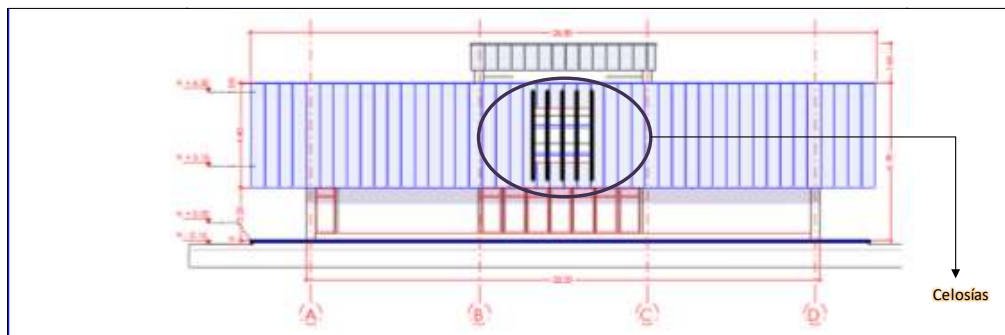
Perdida de concreto en elementos de celosía en fachadas
